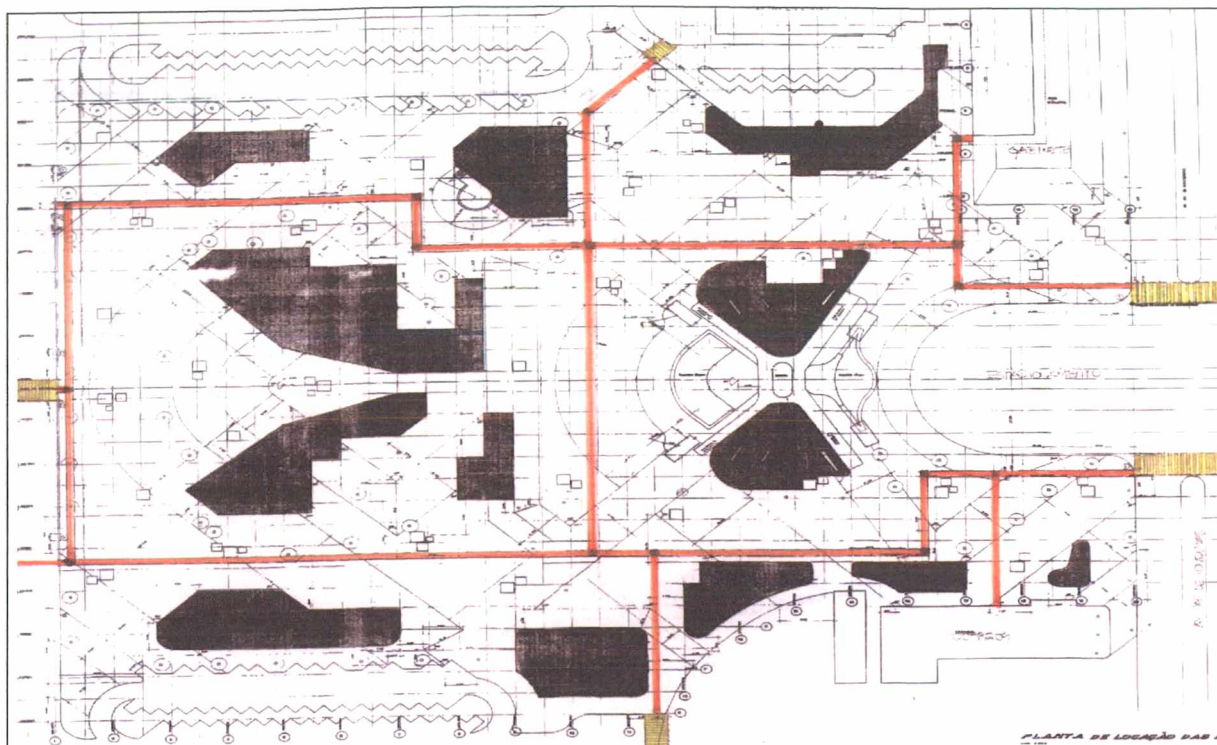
Planta Baixa do Centro de Convivência Comunitário
